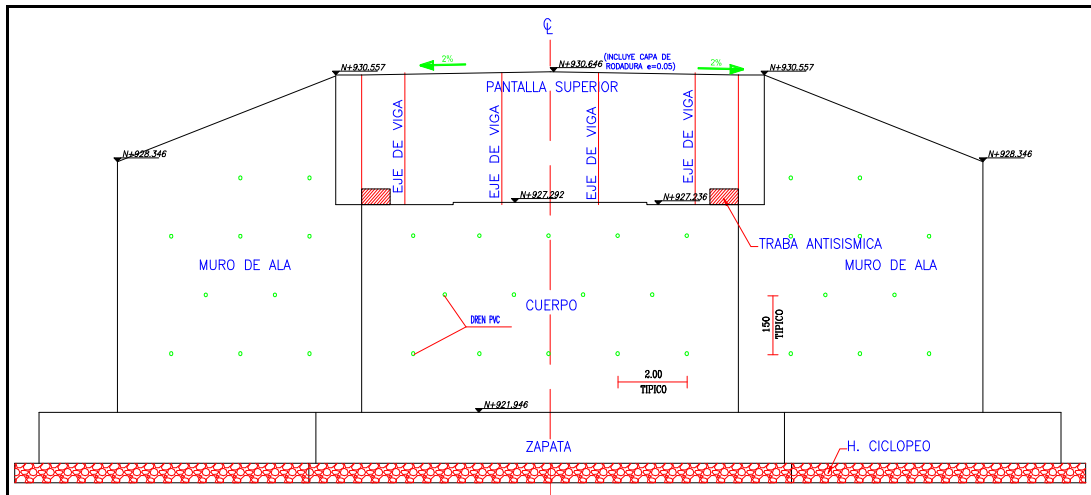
Geometría elevación frontal del estribo. Puente Loco.
